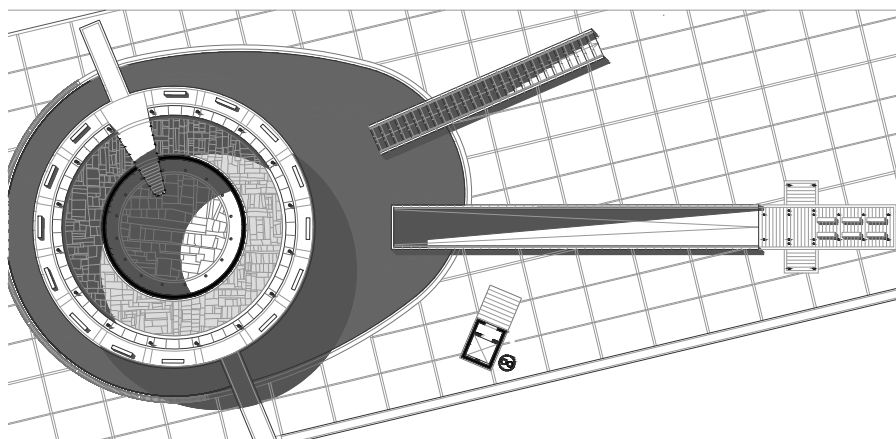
Progetto del museo del Parco delle arti di Jesolo: Pianta
